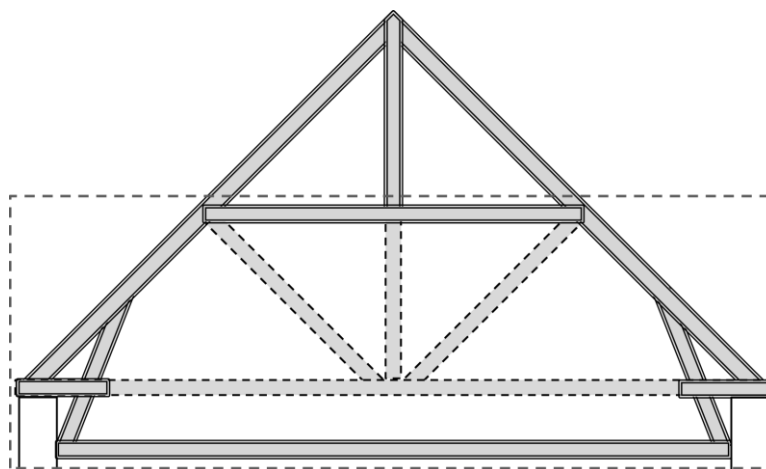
exemple de dégagement de la charpente et d'abaissement du plancher
